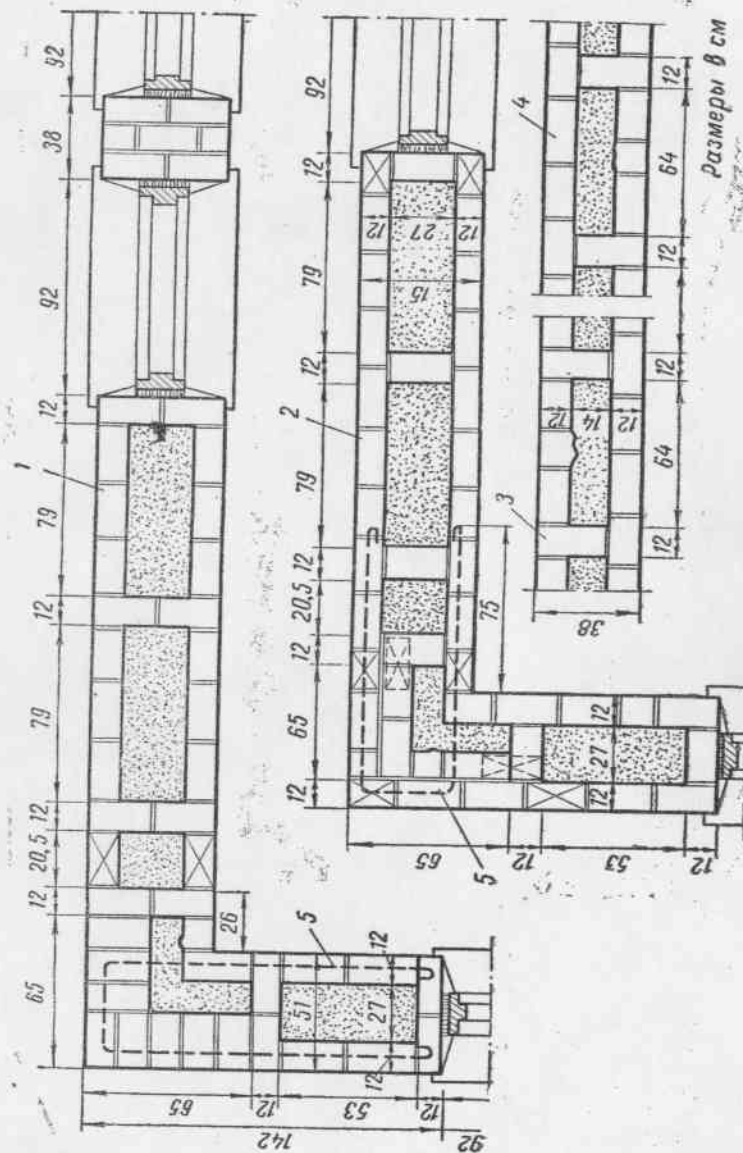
Детали стен колодцевой кладки: 1—план кладки первого ряда и 2—план кладки второго ряда стены толщиной 51 см; 3—план кладки второго ряда и 4—план кладки первого ряда стены толщиной 38 см; 5—арматура диаметром 6—8 мм.
